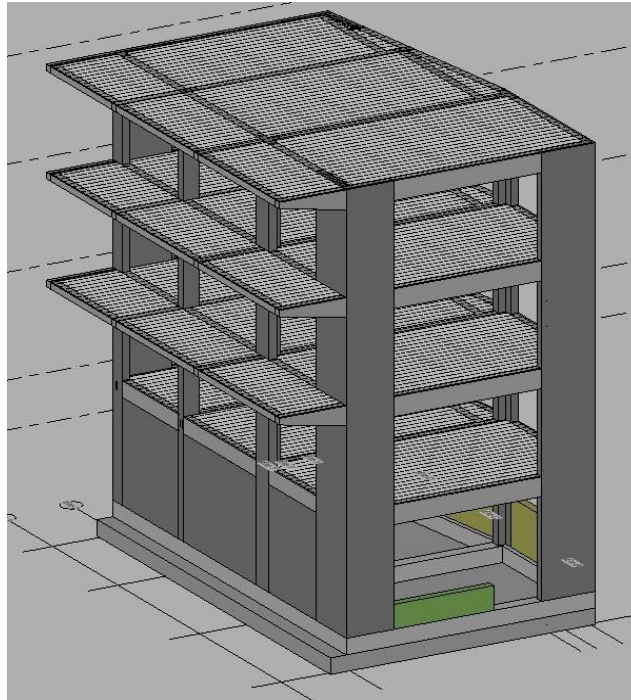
Modelado del concreto del Pabellón N°02 – vista en 3D
